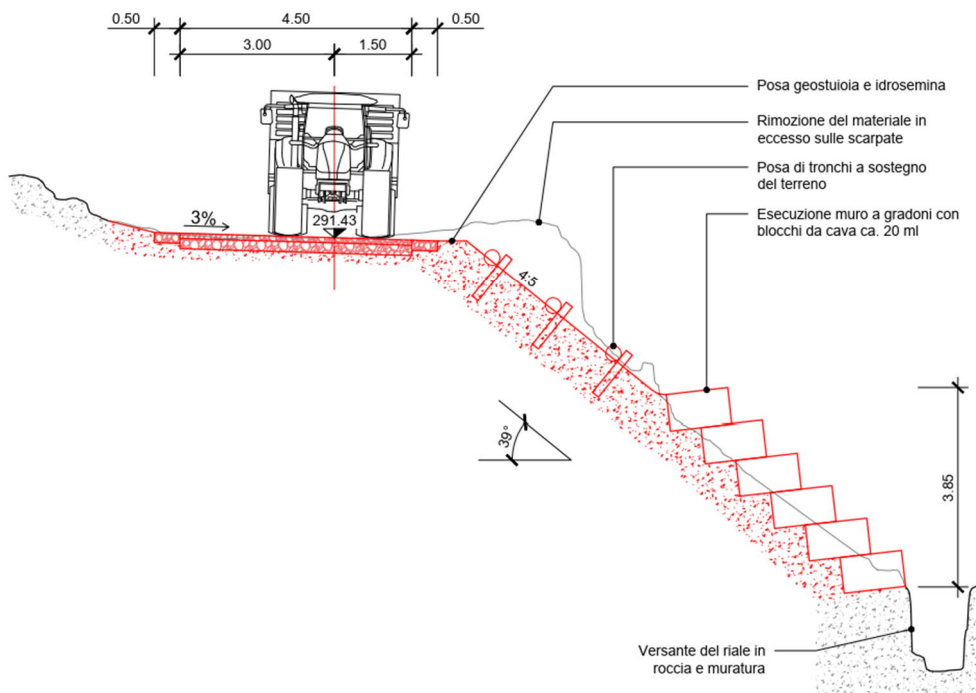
Sezione B-B estratta dal piano "02 - Piano dell'intervento"
